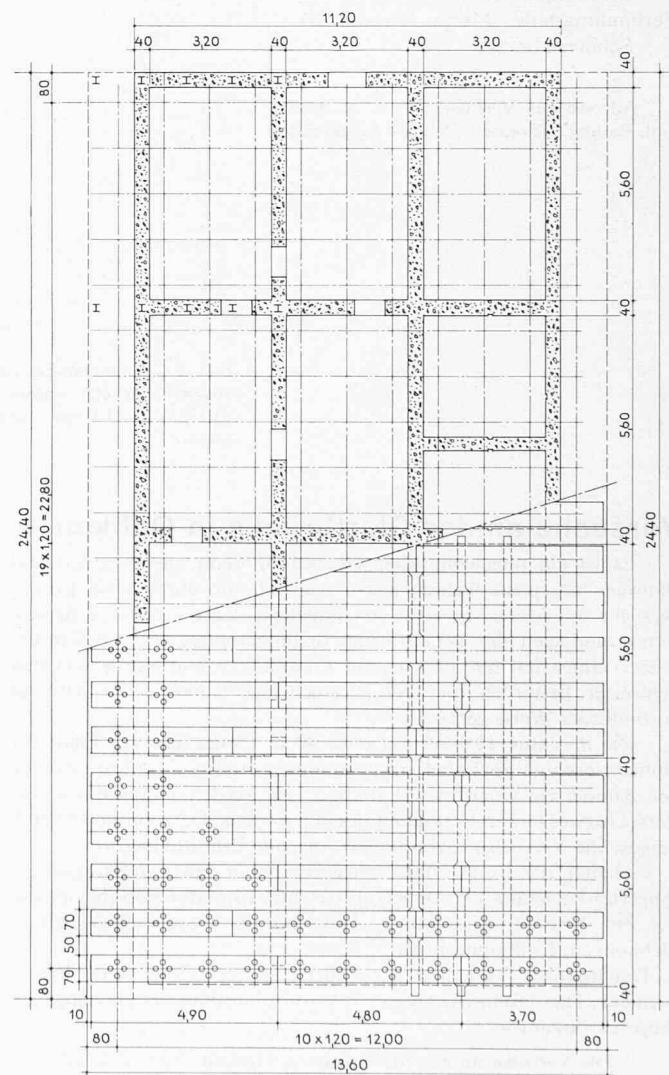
Grundriss 1:200 des Aufspannbodens. Unterer Teil: Draufsicht mit Stahlplatten, Ankerstellen und Walzprofilrost; oberer Teil: Schnitt durch Hohlkasten
